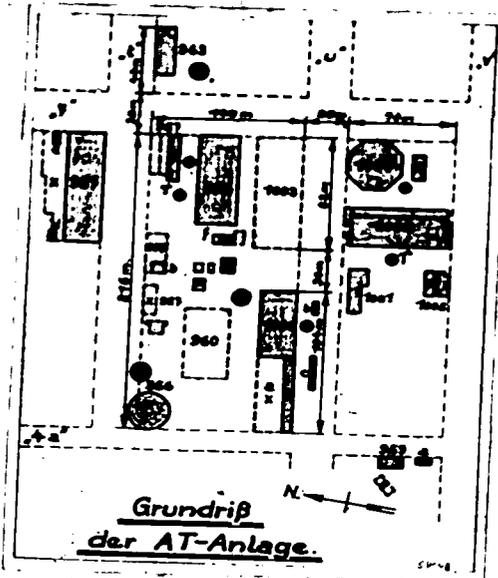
Grundriss der AT-Anlage Leuna.
